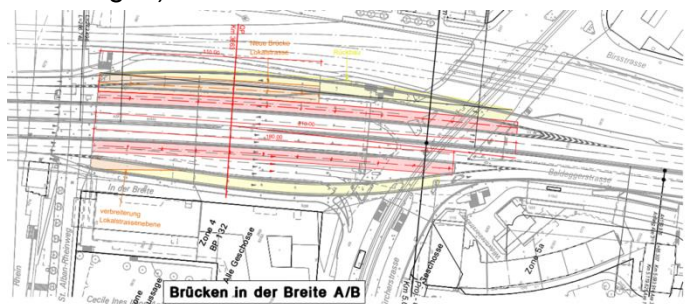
Gelb: Rückbau altes Rampenbauwerk, rot: Neubau Rampen. (Westen = rechts)
